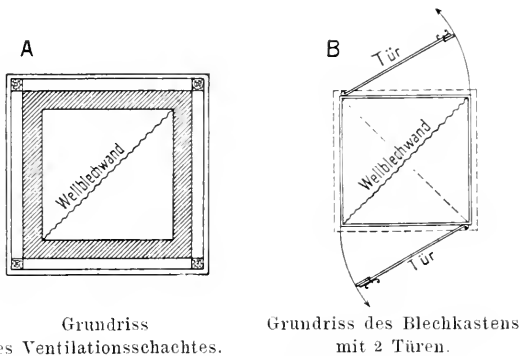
A Ventilations-schacht und B Luftaustrittskasten im Grundriss.
